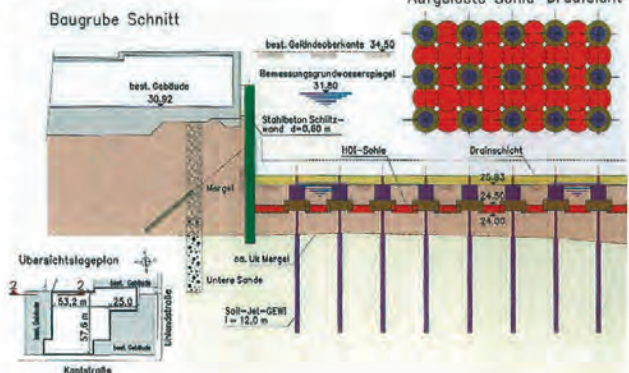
(oben): Baugrube Kantstraße Berlin – Wasserdichte HDI-Sohle mit Soil-Jet-Gewi-Rückverankerung
